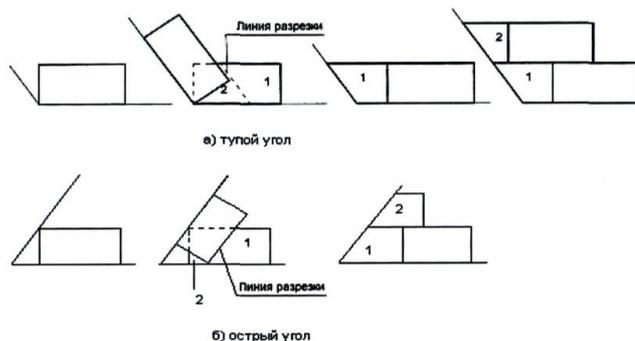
Раскрой и укладка теплоизоляционных плит в углах кровли
